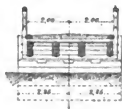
Herstellung der Fußwege holzerner Brücken.
